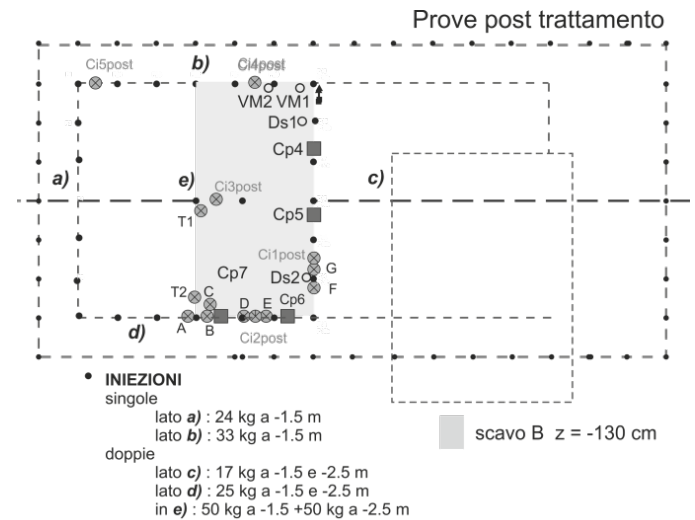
planimetria e ubicazione del campo prove post trattamento.
